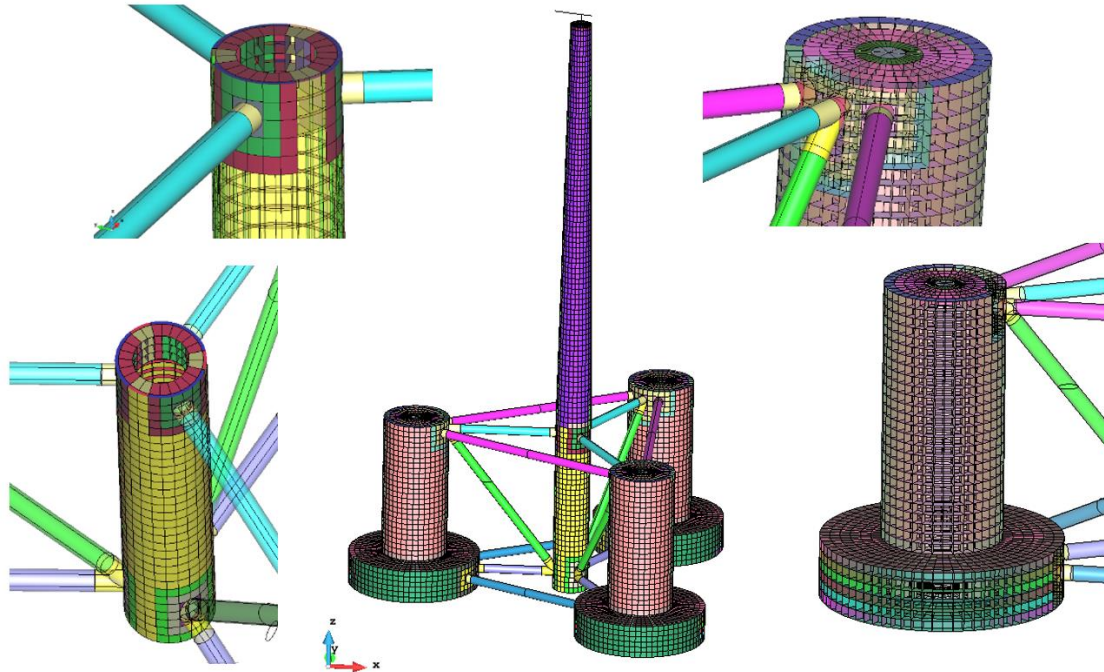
Diseño estructural y detalles de la CIMNE-DeepCwind.
